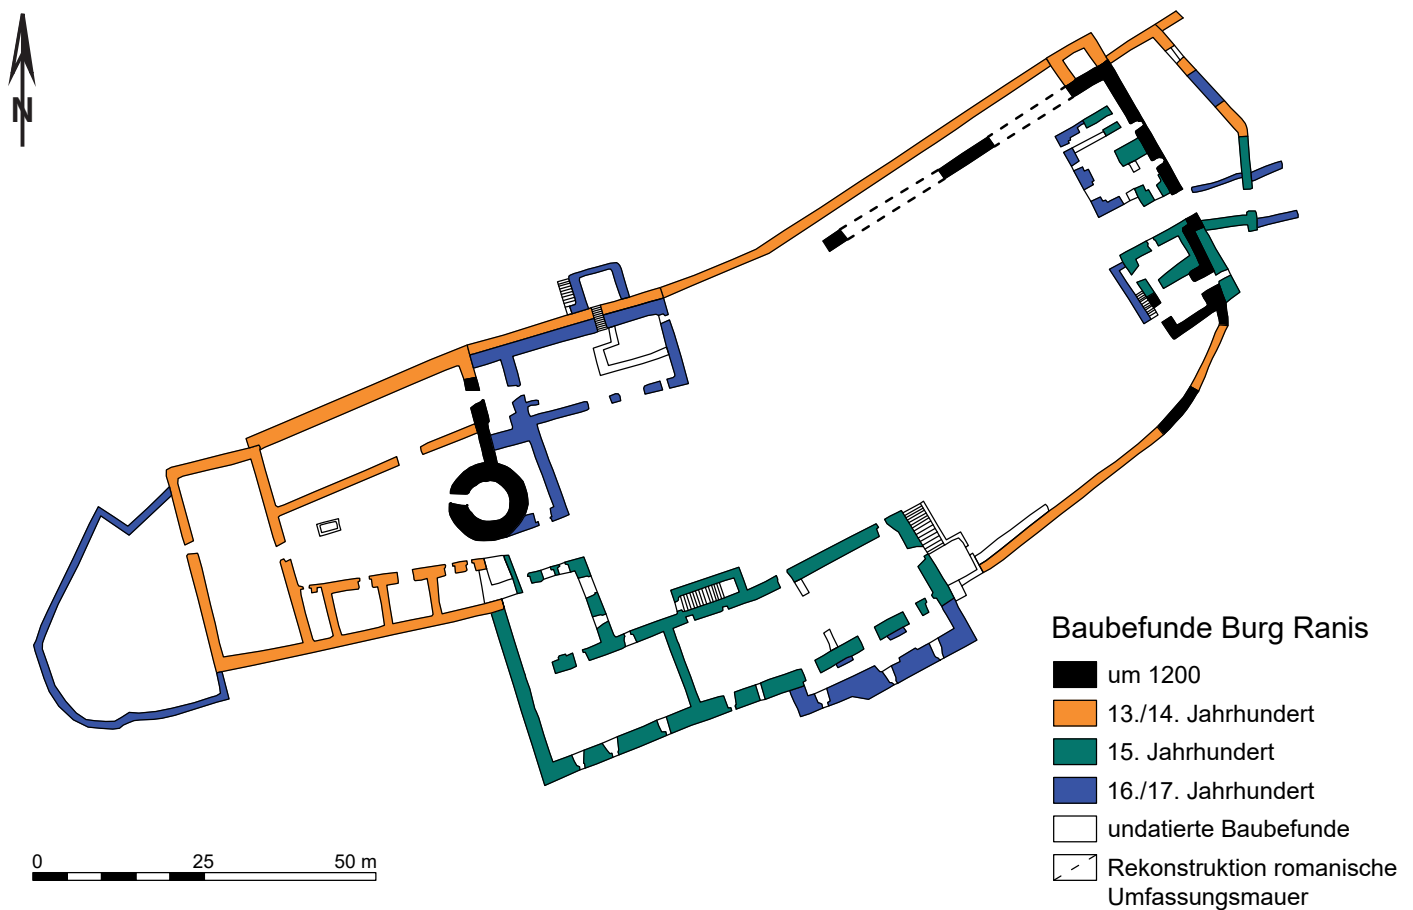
| Grundriss der Raniser Burganlage.
